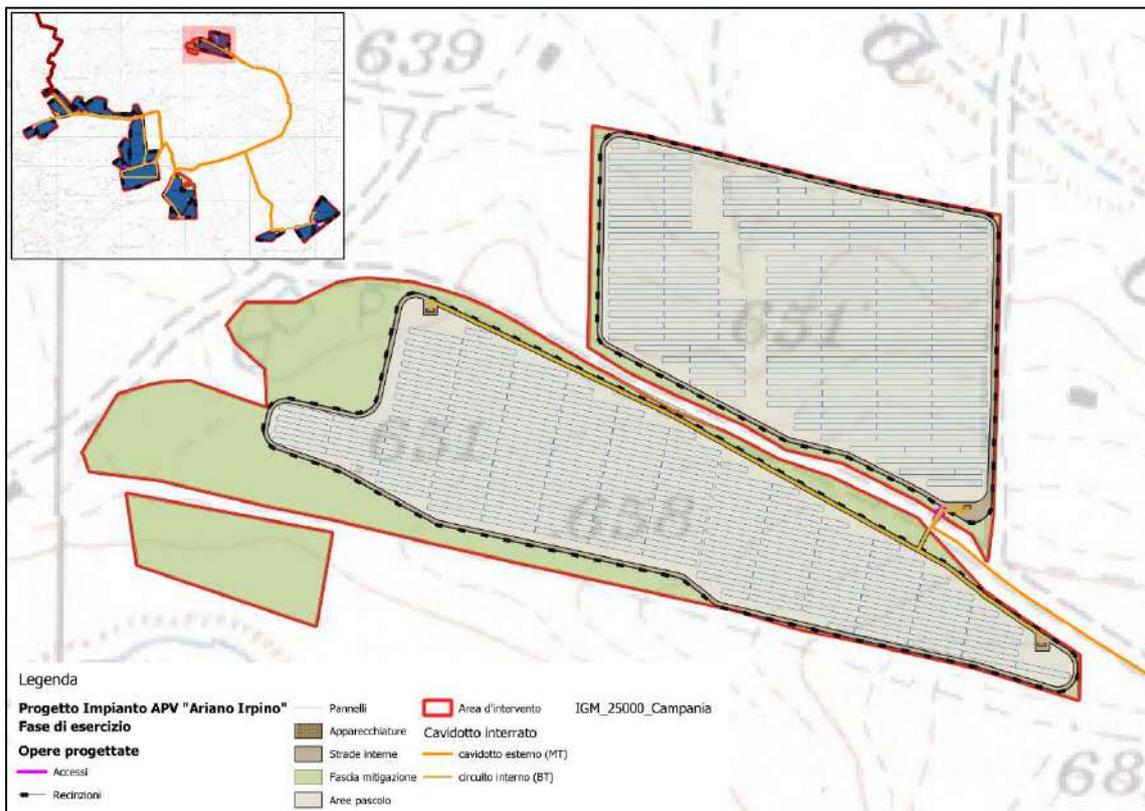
planimetria riportante i campi fotovoltaici in fase di esercizio
